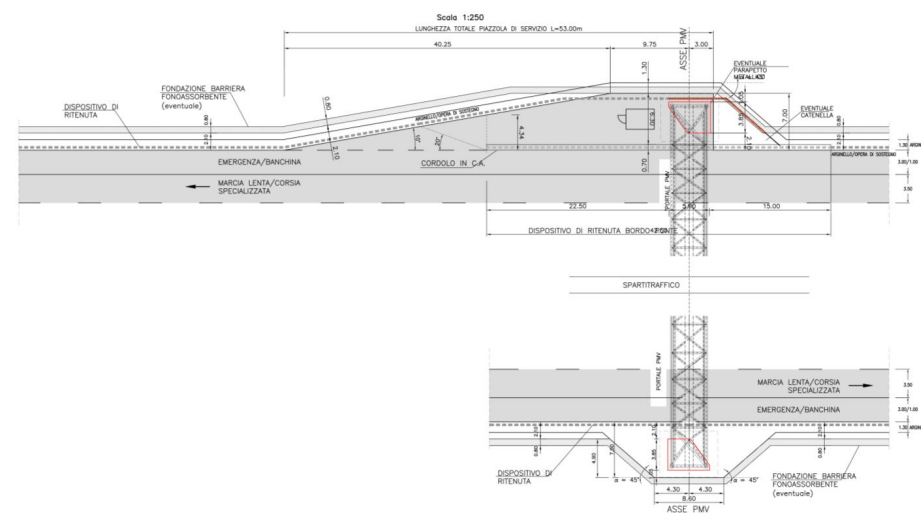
Stralcio planimetrico piazzola di servizio portale PMV
